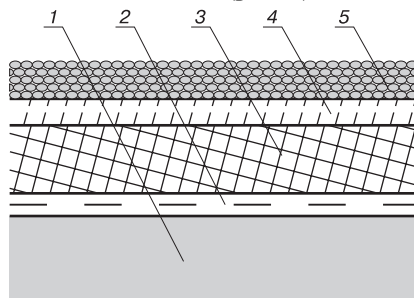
Устройство кровли «наоборот» с применением плит «Пеноплэкс»: 1 – перекрытие; 2 – гидроизоляция; 3 – «Пеноплэкс»; 4 – защита от осыпи; 5 – пригрузочный слой
